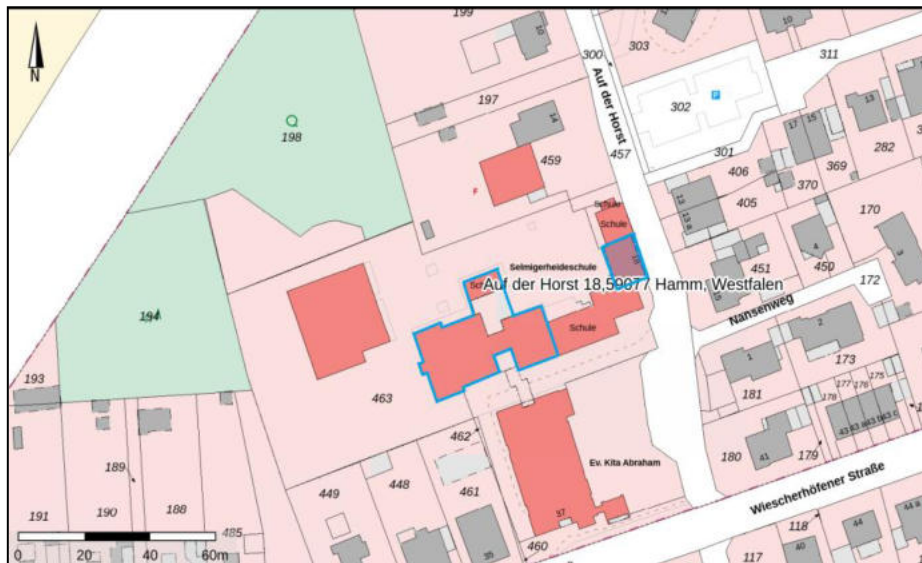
Lageplan der Gebäuden A2 und OGS Horst Straße 18, 59077 Hamm
